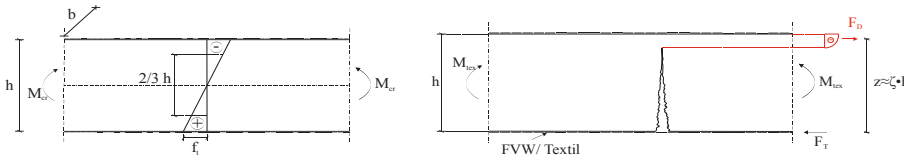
Mauerwerksbalken unter reiner Biegung bei Erstrissbildung: Links: Unverstärkter Mauerwerksbalken – Rechts: Textilverstärkter Mauerwerksbalken
